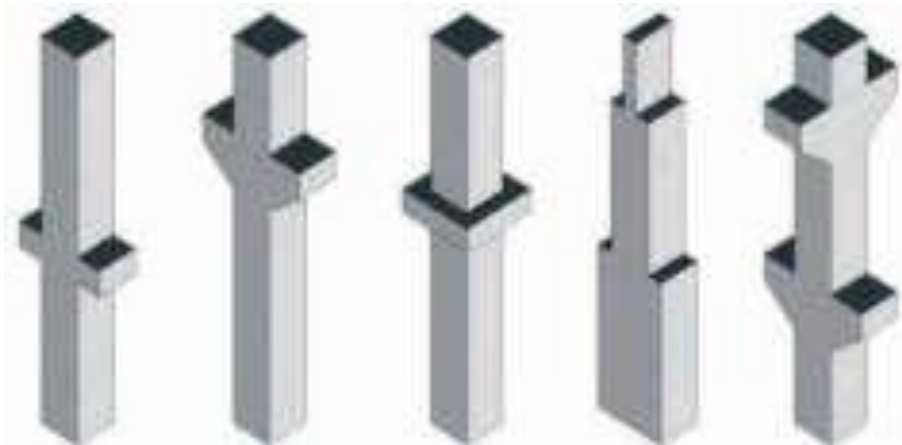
Alcuni tipi di mensola per le strutture in elevazione verticale prefabbricate.
